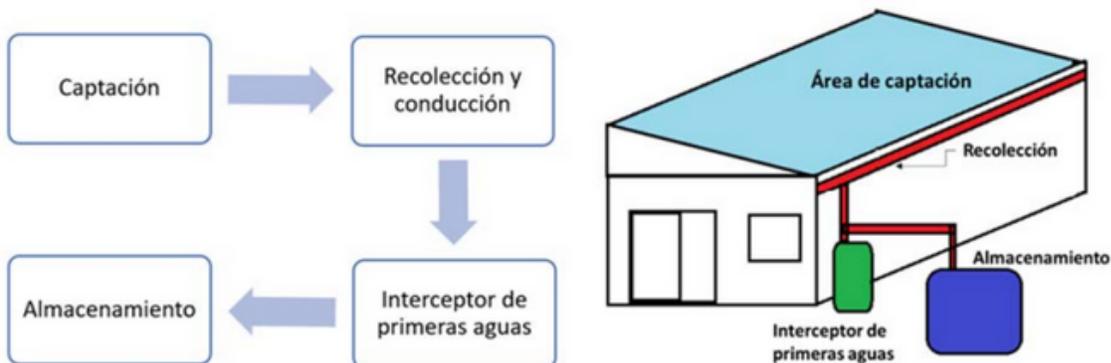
Esquema simplificado de los componentes del sistema de captación de agua pluvial para la planta de secado.
